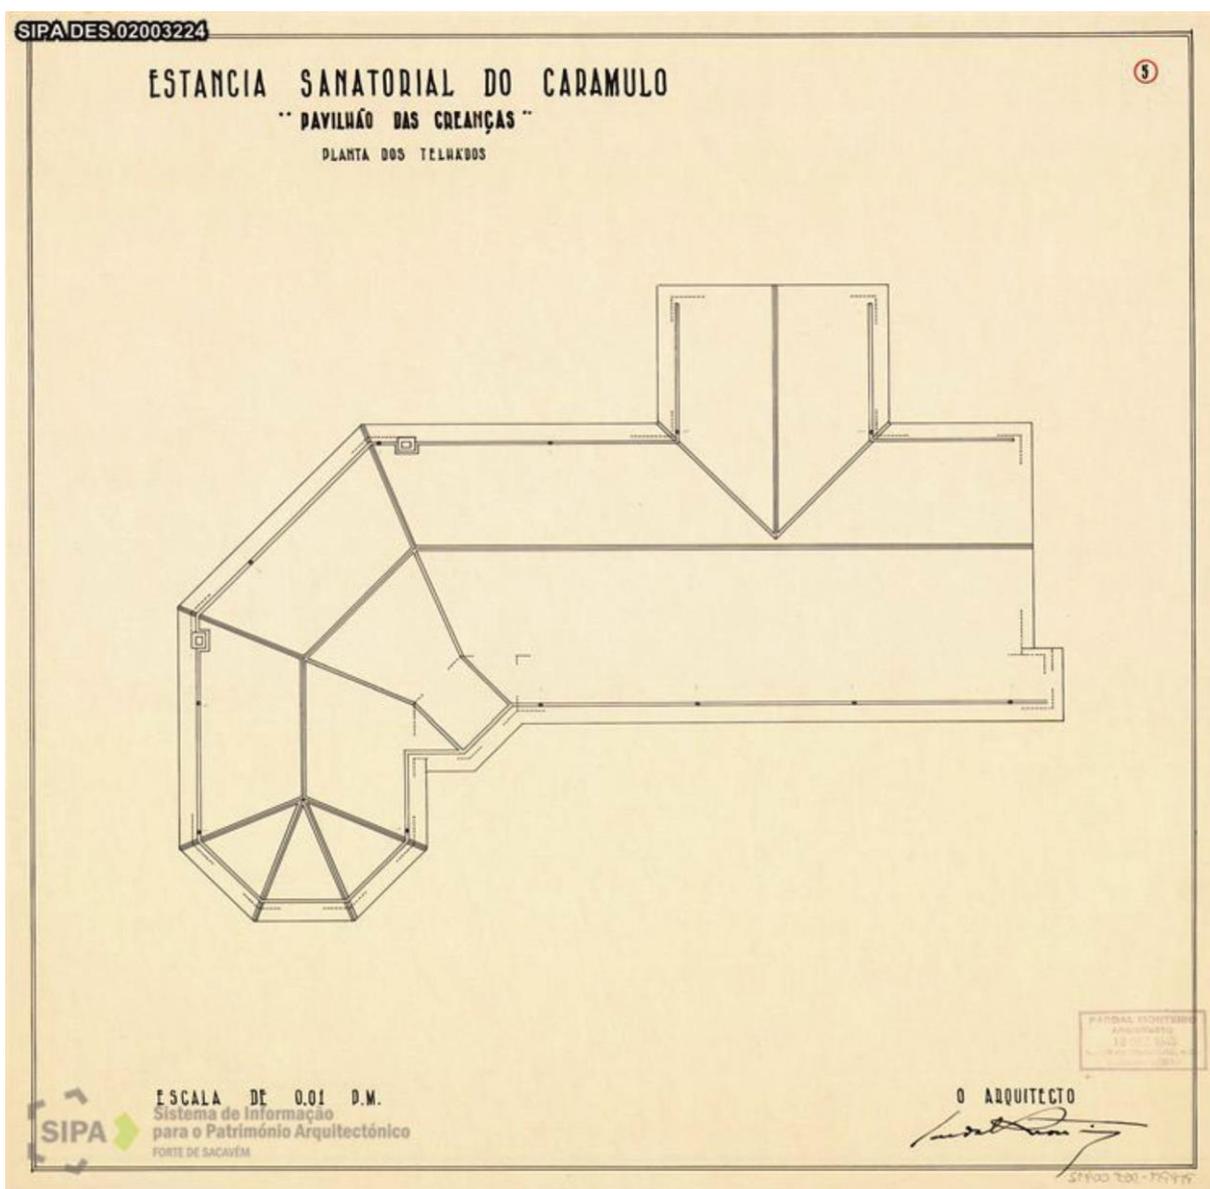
Planta de cobertura – projeto de Pardal Monteiro
